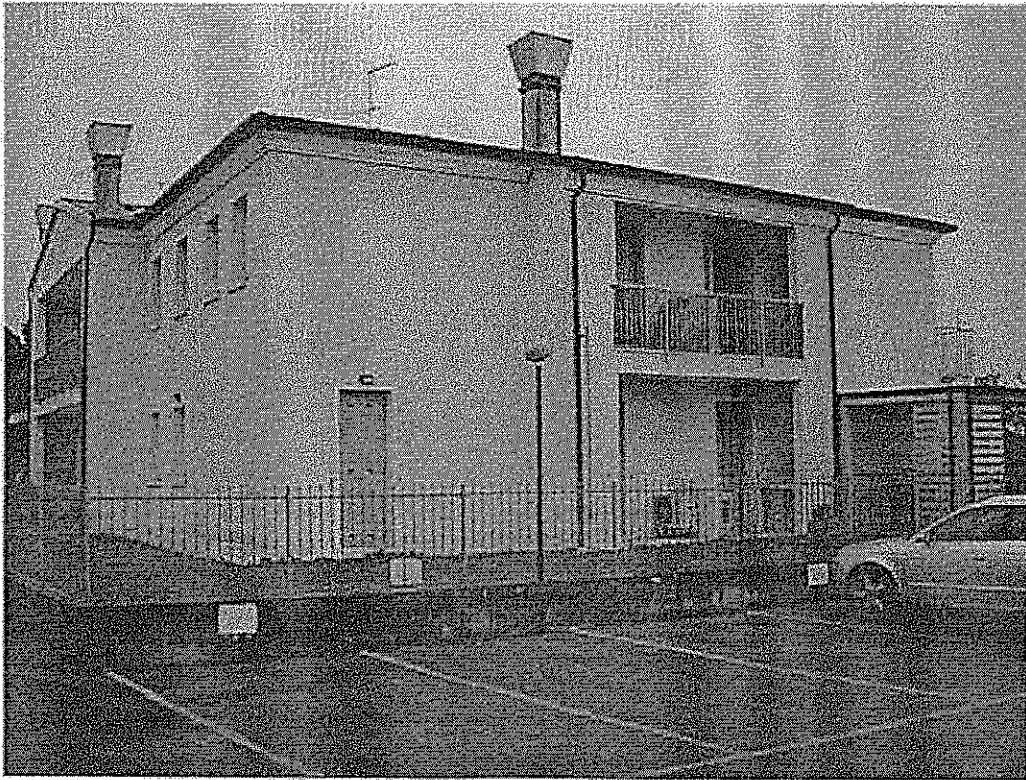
Come foto N° 1 con vista da nord-ovest.
